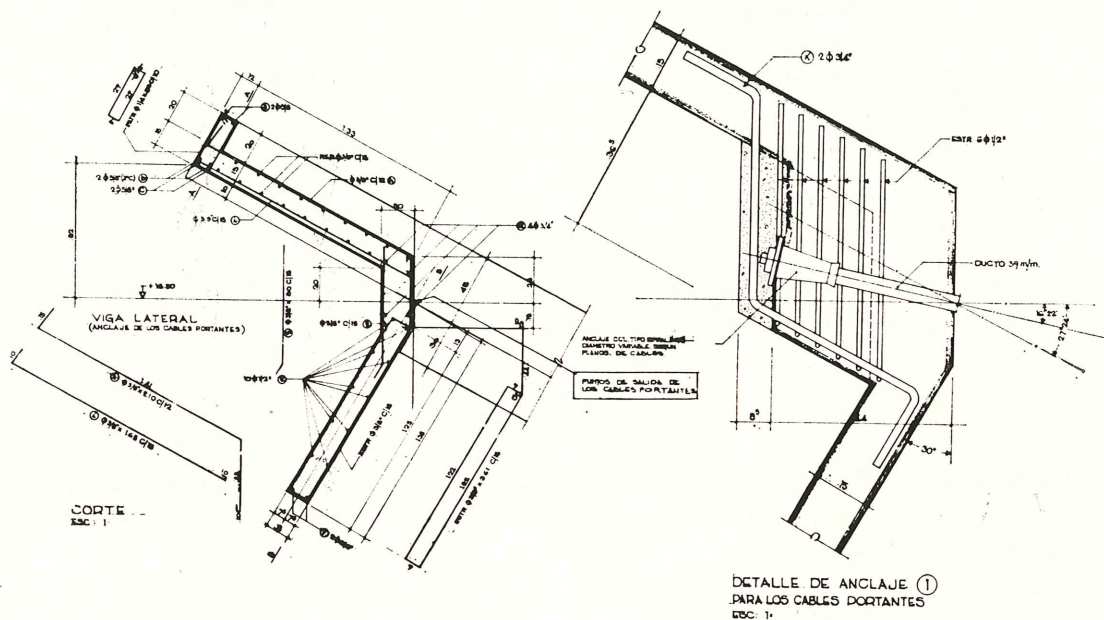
Detalle de anclaje de los cables portantes en la viga lateral.
